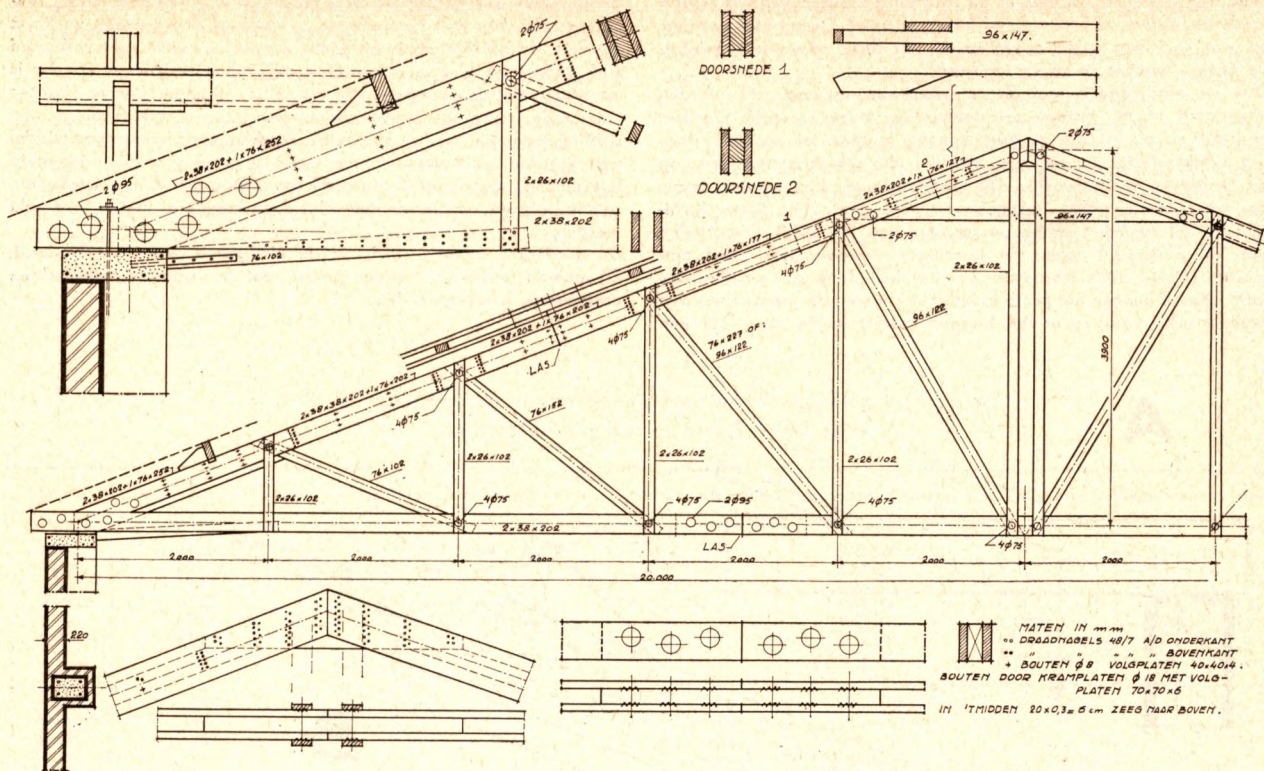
Spantconstructie voor een overspanning van 20 meter
